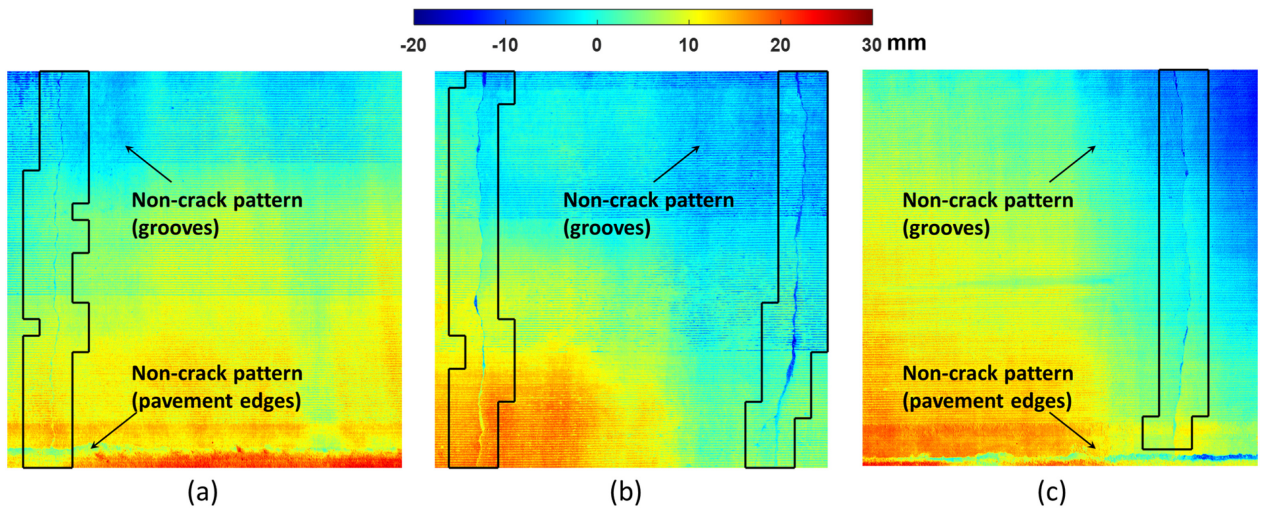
Clasificación de grietas en pavimentos mediante escáner láser. Fuente: [10]
